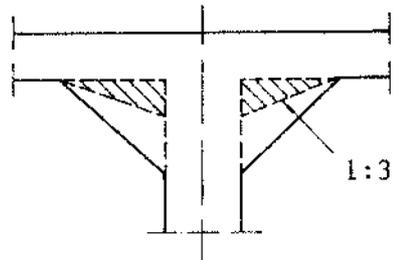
Consideración de un refuerzo en el dimensionamiento a flexión.
